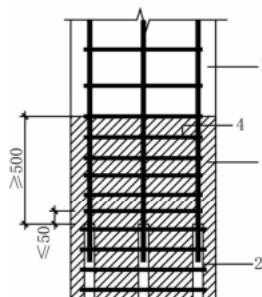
钢筋采用套筒灌浆连接时柱底箍筋加密区域构造示意
